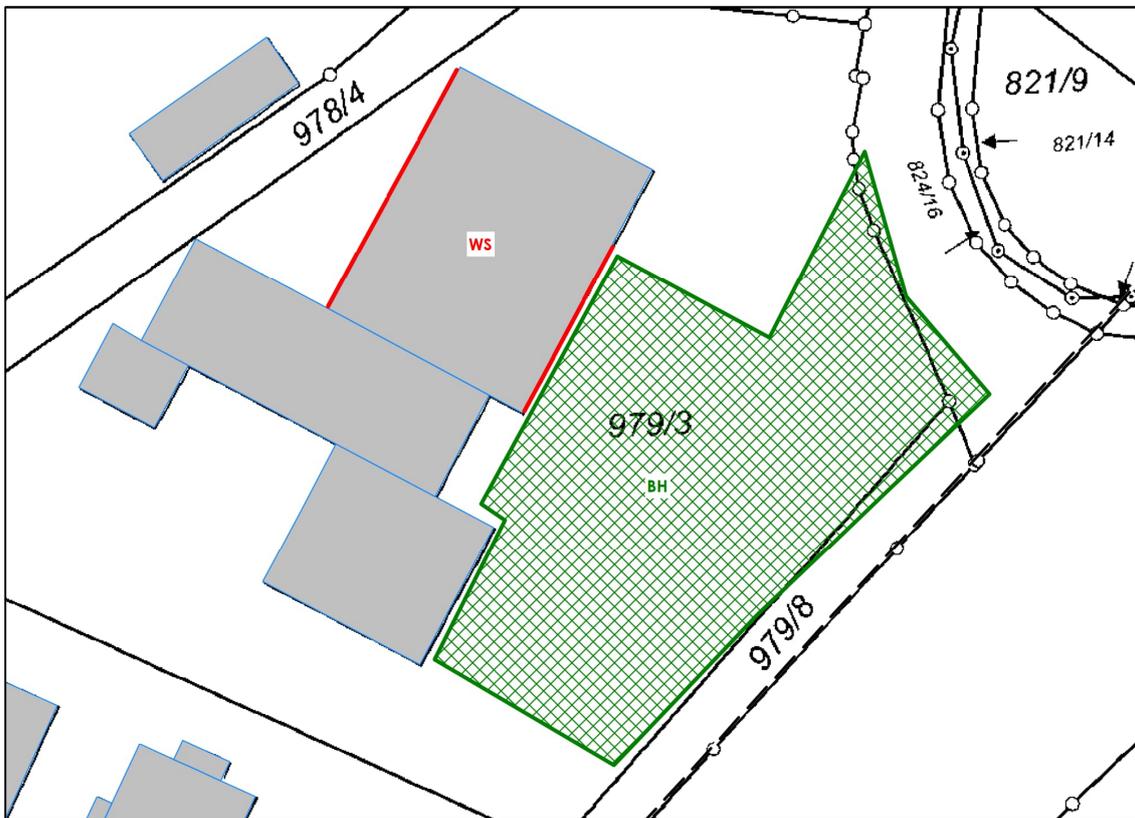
Lageplan mit Darstellung der relevanten Schallquellen
